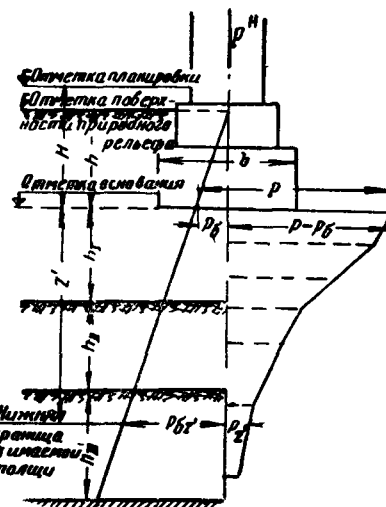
Расчетная схема распределения давления на горизонтальных сечениях в грунте ниже подошвы фундамента
